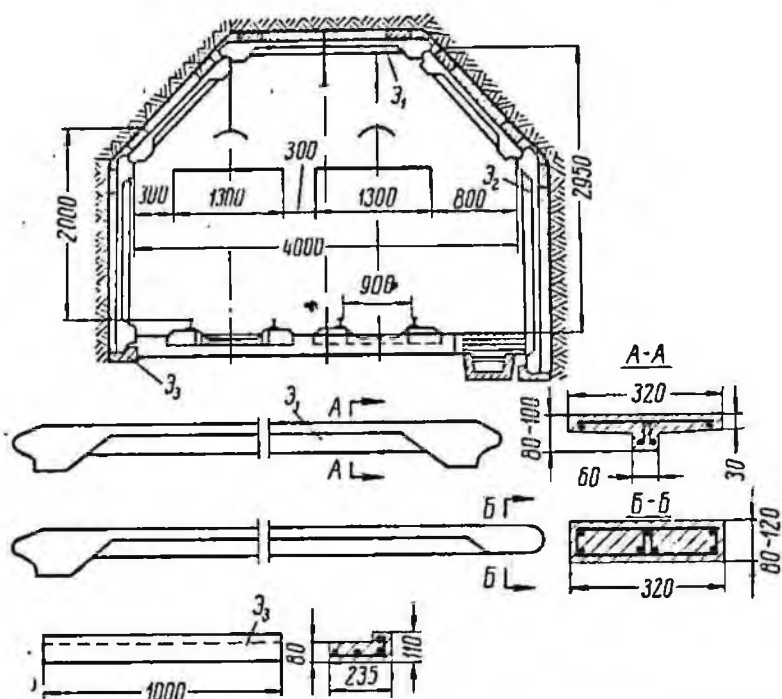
Сборная железобетонная крепь из универсальных тавровых элементов (УТЭ)
